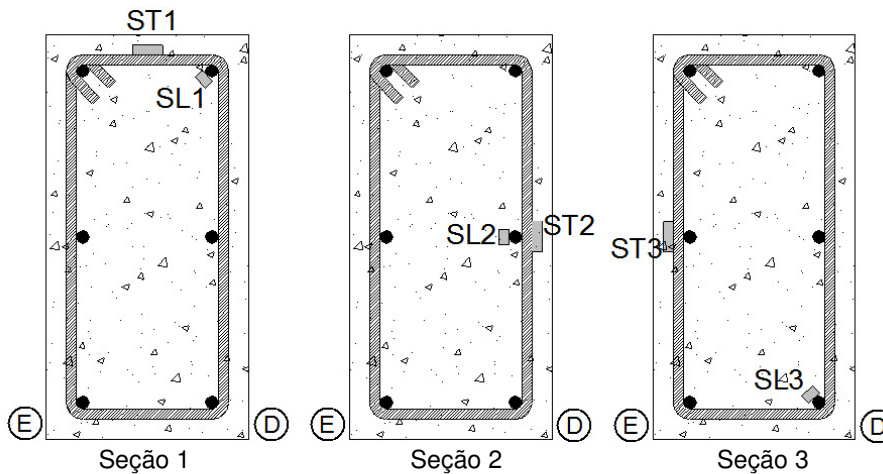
Detalhe das seções onde a armadura foi instrumentada.
